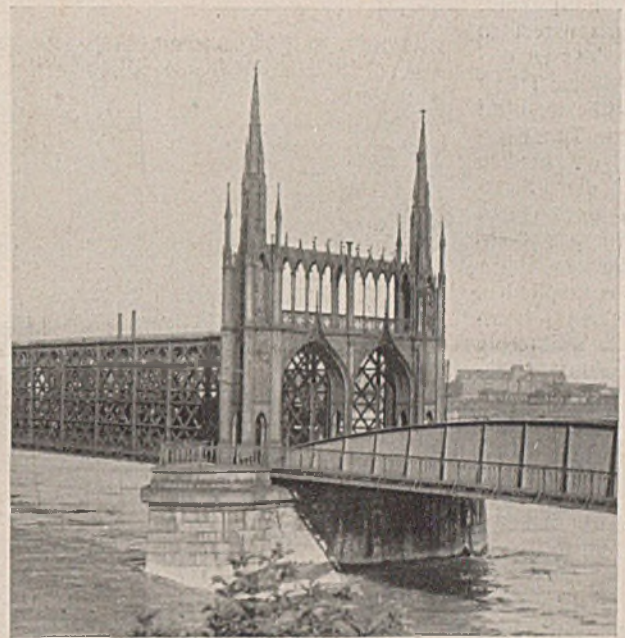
Strombrücke mit gußeisernen Portalaufbauten.
